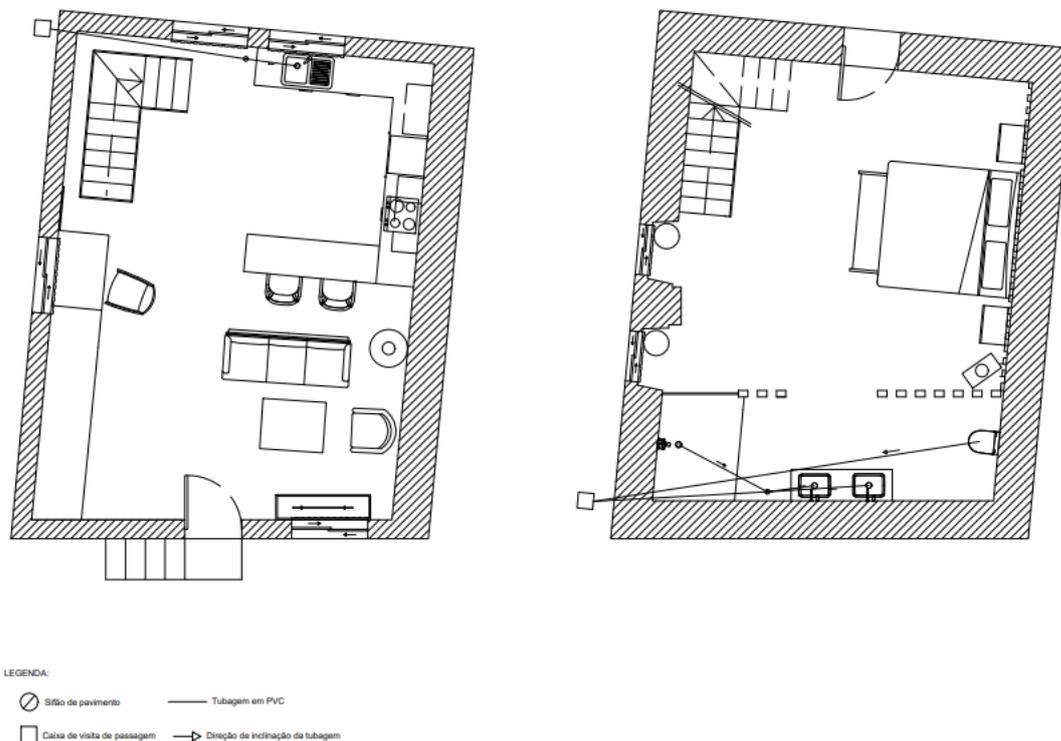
Planta de esgotos piso 0 e piso -1. Fonte: Maria Leonor.
